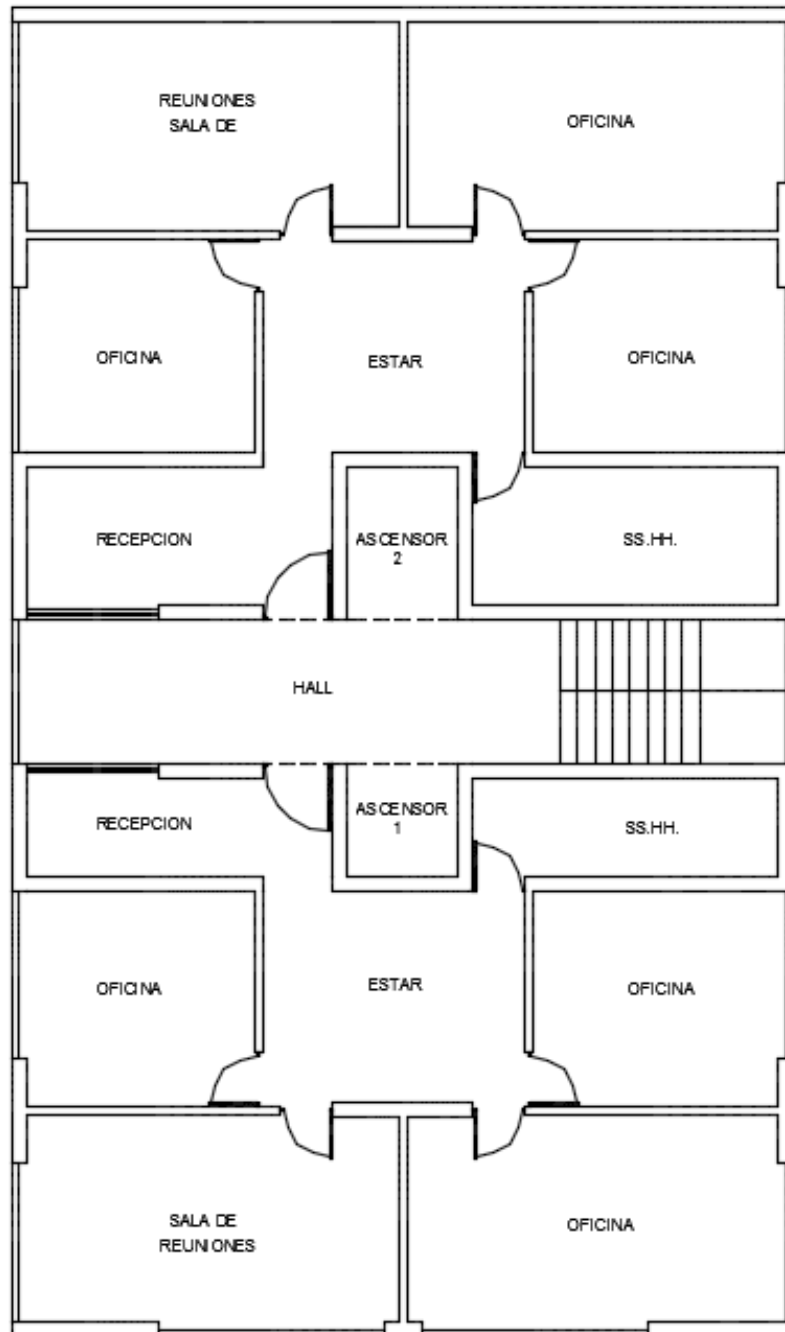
Planta de arquitectura de segundo a noveno nivel
